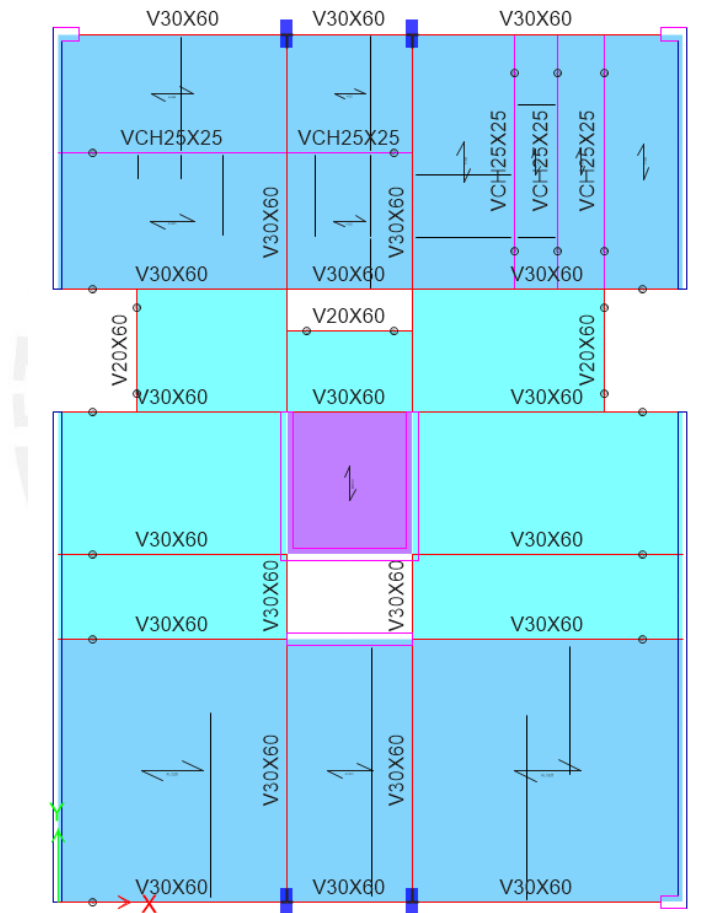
Planta típica del edificio modelado en *ETABS*.
